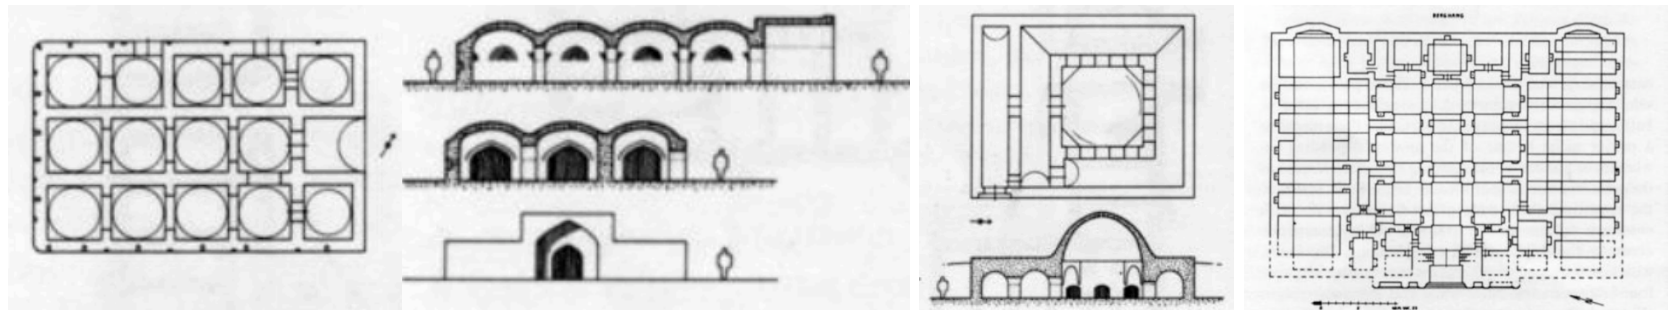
Planta y sección de caravasares de montaña en *Katunbad*. | Imagen 14. Planta y sección de caravasar de montaña en *Gambūj*, al este de *Tehran* en la ruta a *Amol*. | Imagen 15. Planta de caravasar de montaña en *Gadūk* cerca de *Firūzkūh
